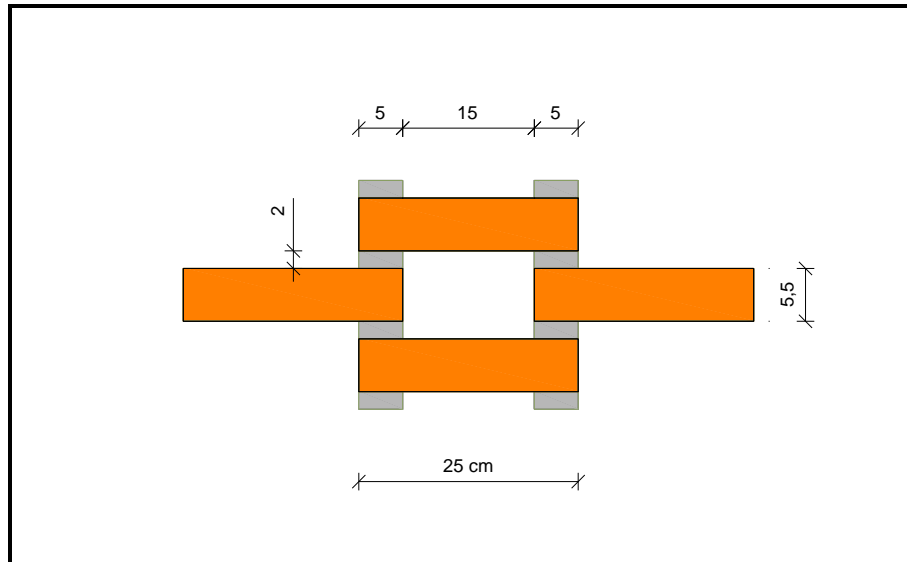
Detalle de Intercalado de ladrillos existentes
